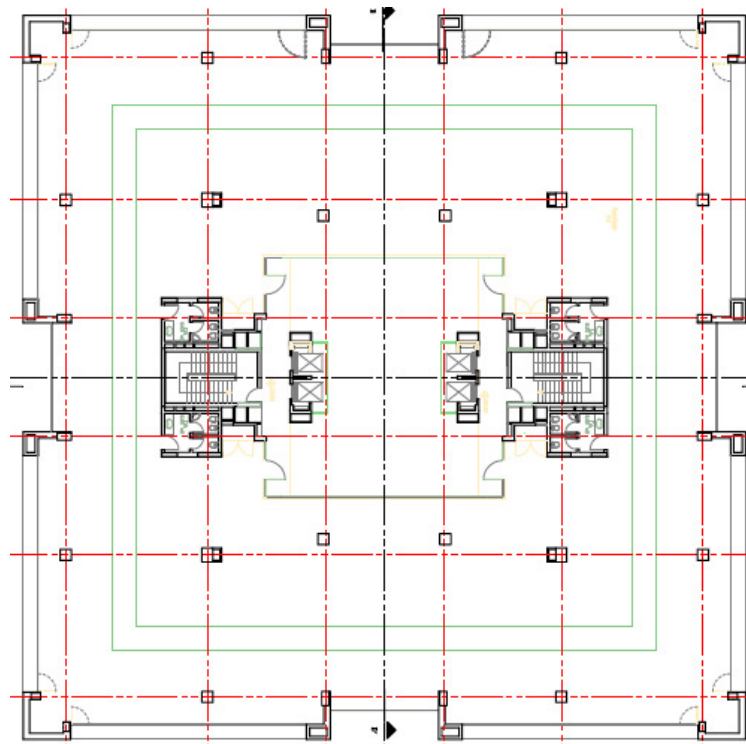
Planta do piso 2 do Edifício em estudo
